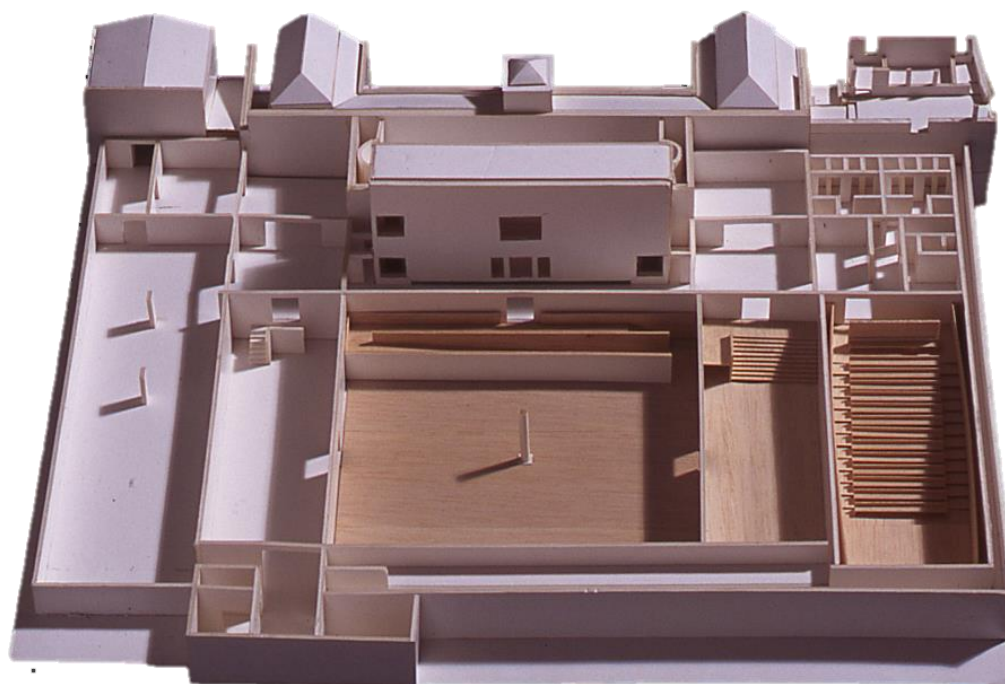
Maquete da 6ª Fase do Plano Conjunto do Museu, s/d; Atelier Bernardo Távora
